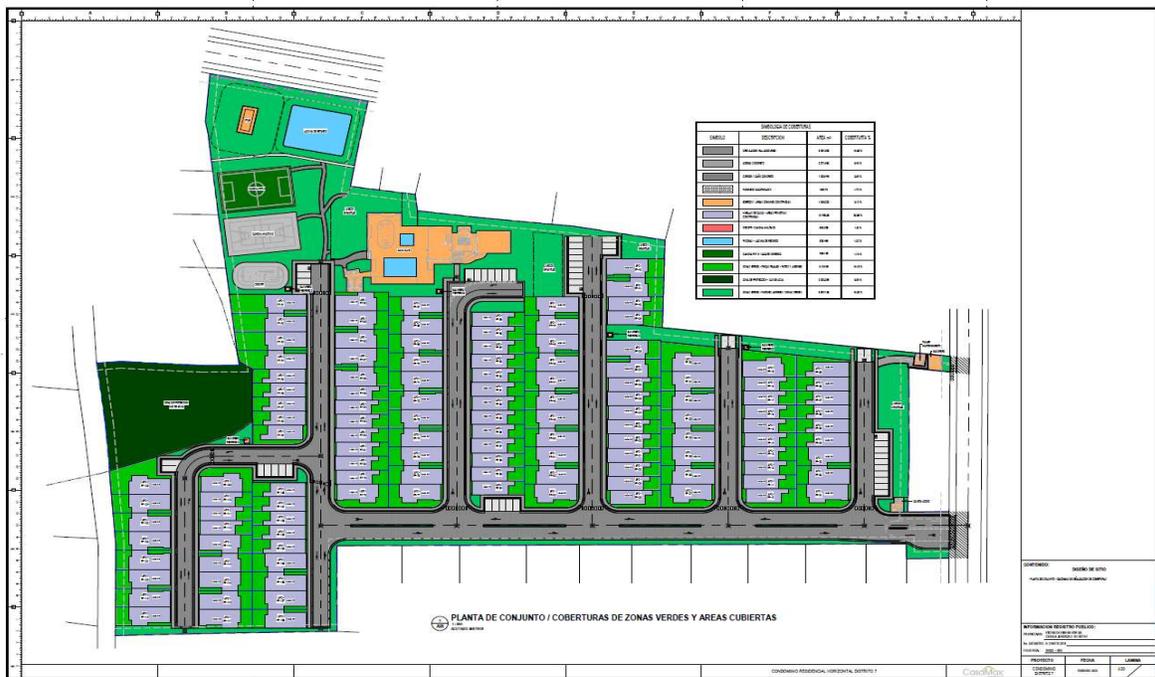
Diseño de Sitio Coberturas. Fuente lámina constructiva # A20.
